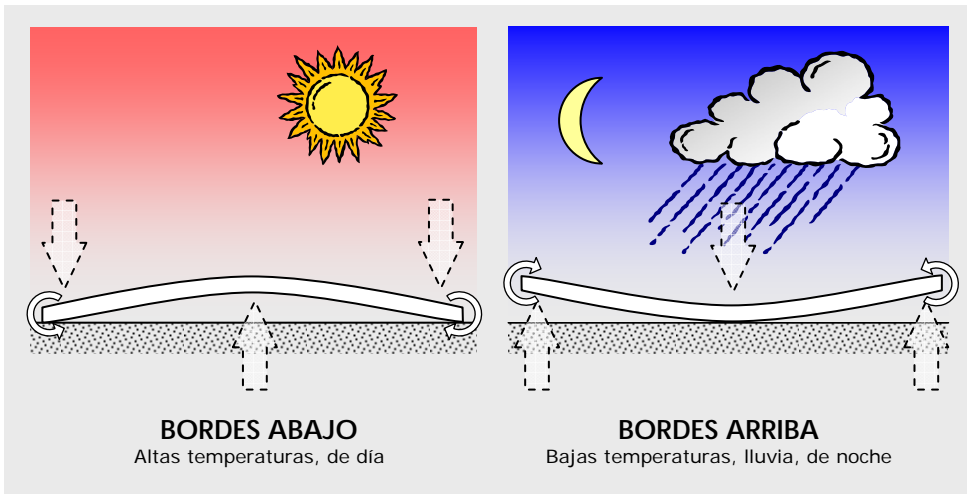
Efecto de la temperatura sobre las losas de hormigón
